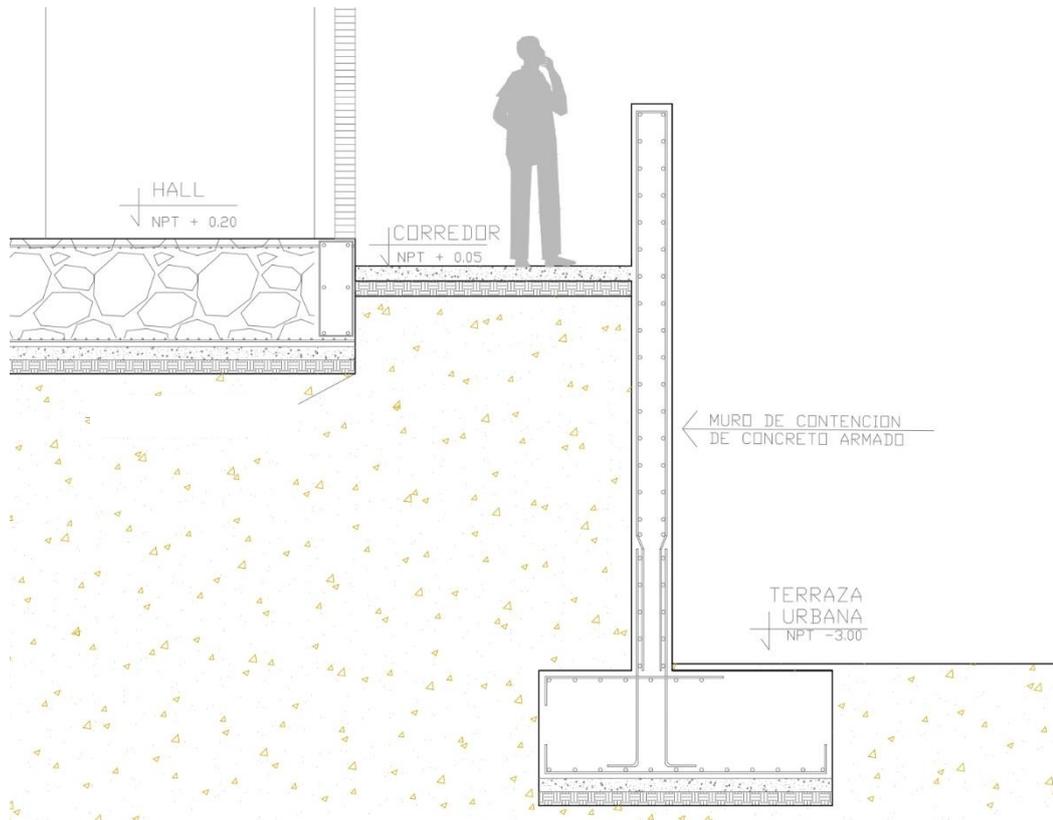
Sección estructural de zapata conectada y cimentación corrida de centro comunitario.
